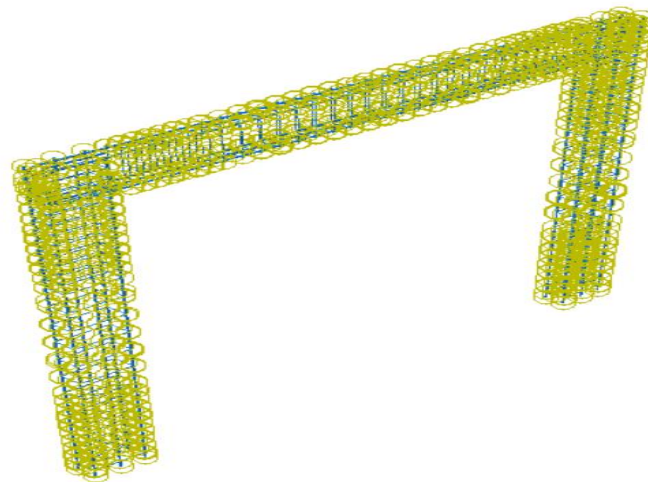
Assemblage de la poutre renforcée par les aciers et supportée par les poteaux
